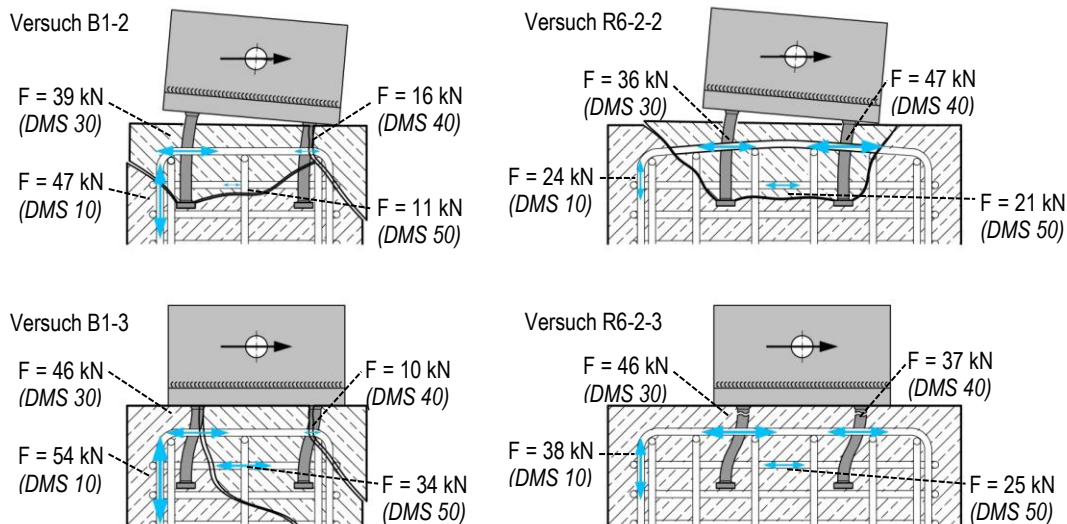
Zugbeanspruchungen in den Bewehrungsbügel bei Höchstlast der Versuche B1-2, B1-3, R6-2-2 und R6-2-3 in kN
